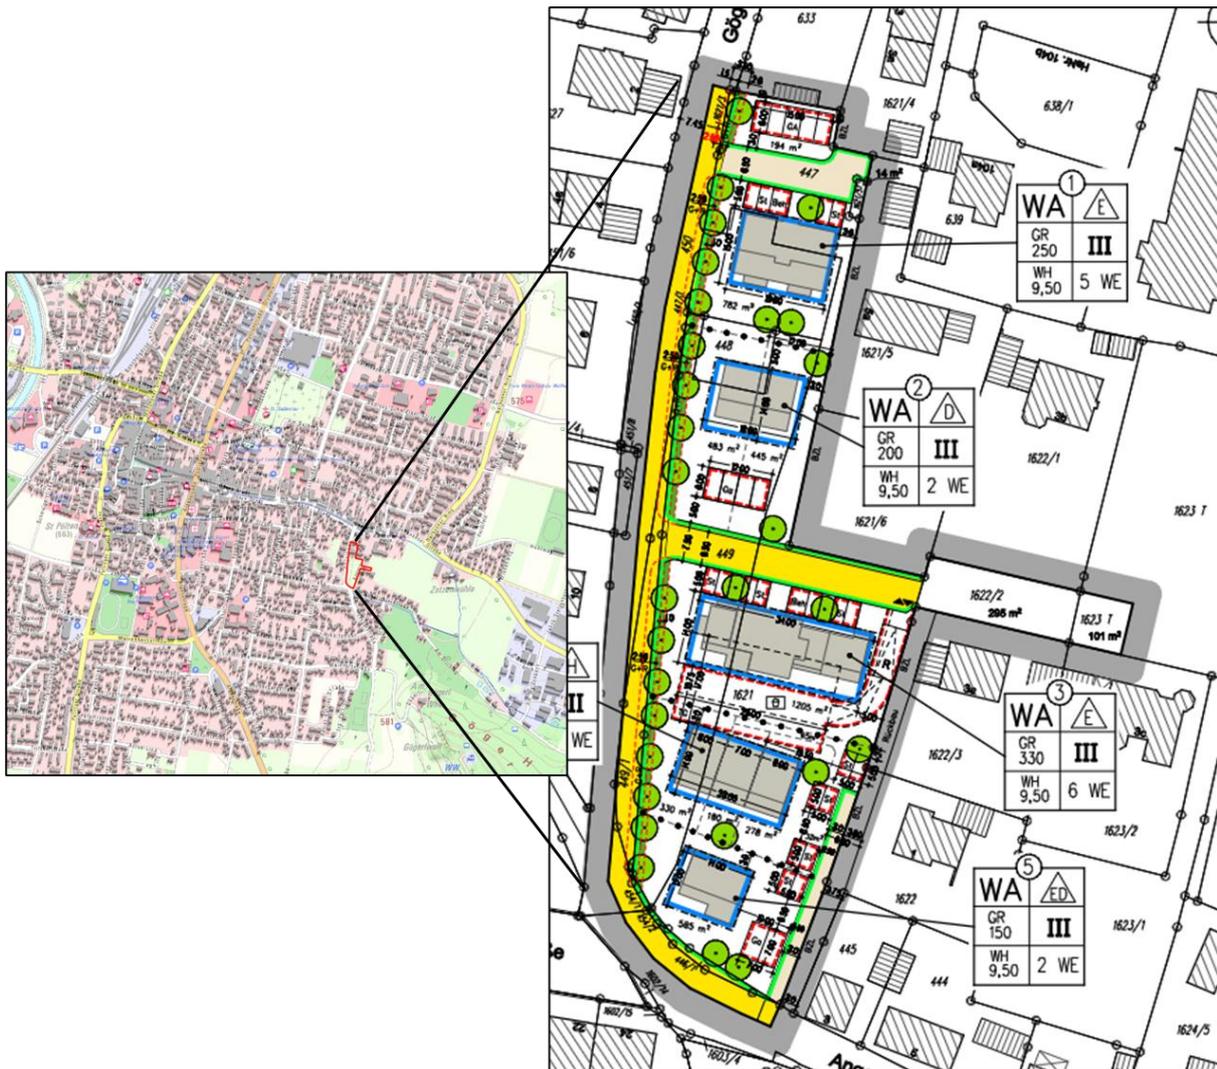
Bebauungsplan „Am Gögerlweg“
